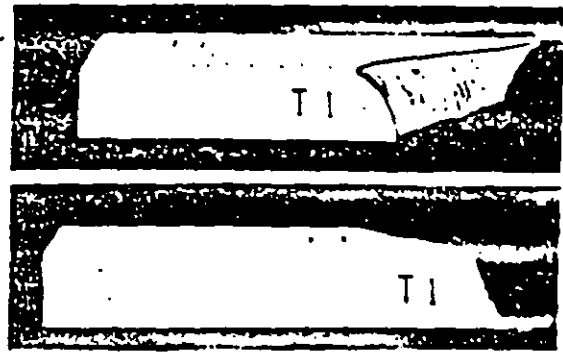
Viga de mortero simple en torsión pura (a) Vista superior ; (b) Vista inferior
